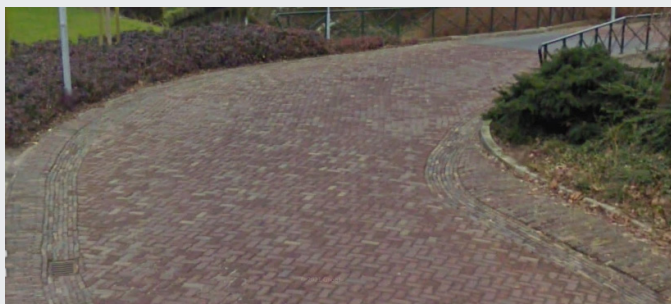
Bestrating in heidepaarse betonklinker en 30*30 betontegels
